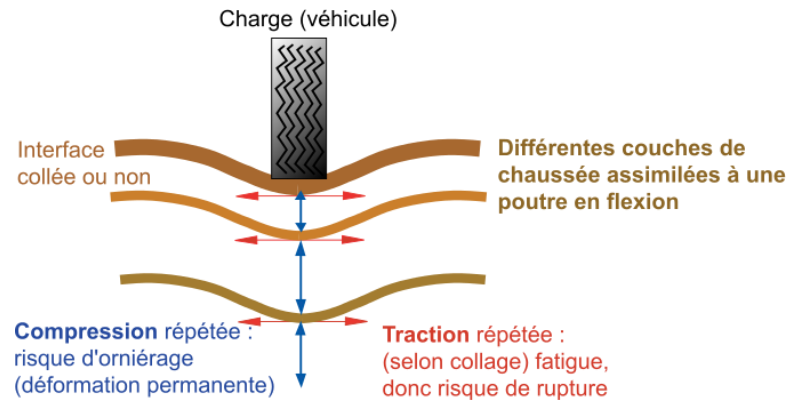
Schéma de fonctionnement d'une structure de chaussée sous l'application d'une charge roulante
